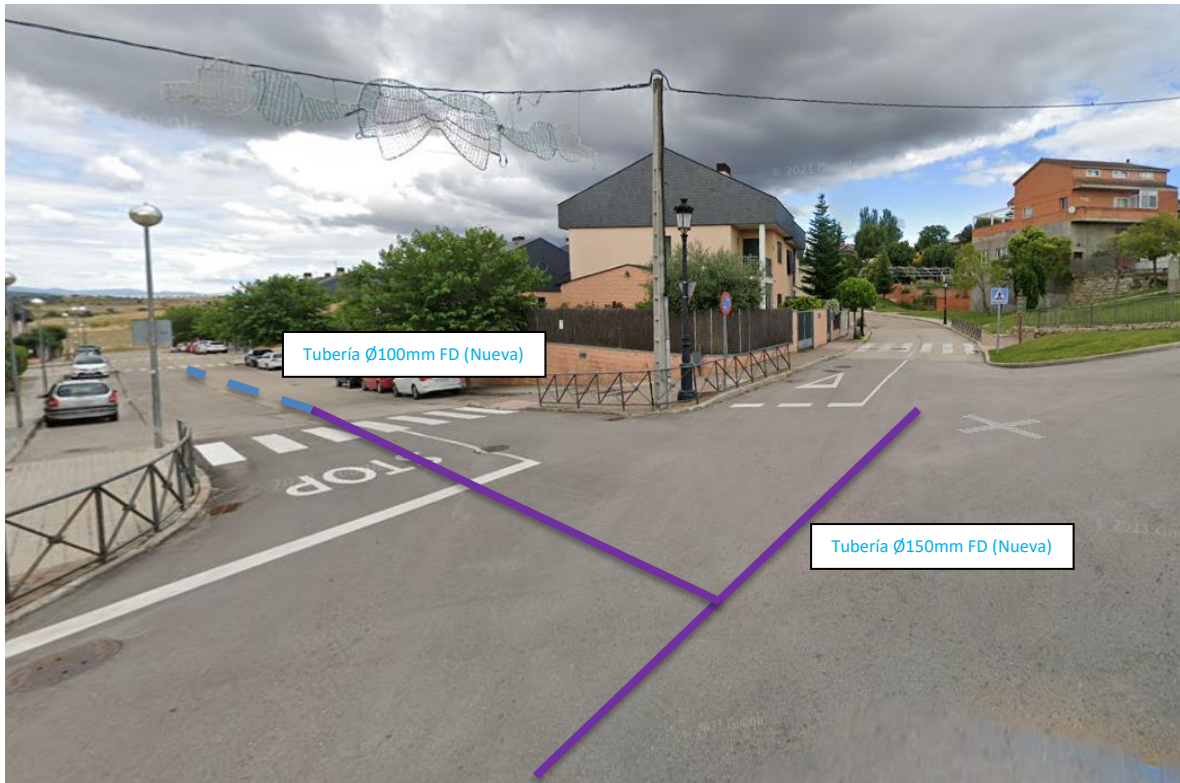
Intersección entre la Av. De Burgos y la Av. De Madrid. Parte de la tubería discurre por la calle San Juan Bautista.
